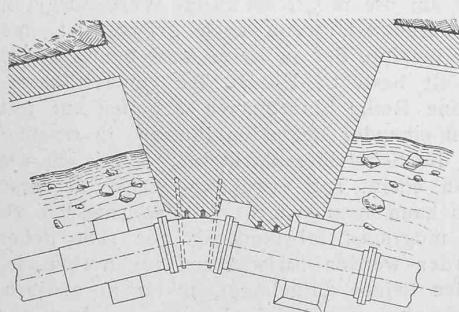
Hintermauerung (Grundriss). 1 : 100.
